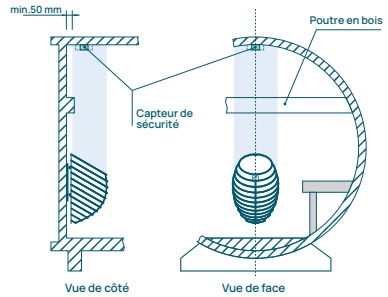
Installation du capteur de sécurité au plafond dans les saunas tonneau : chauffage mural
